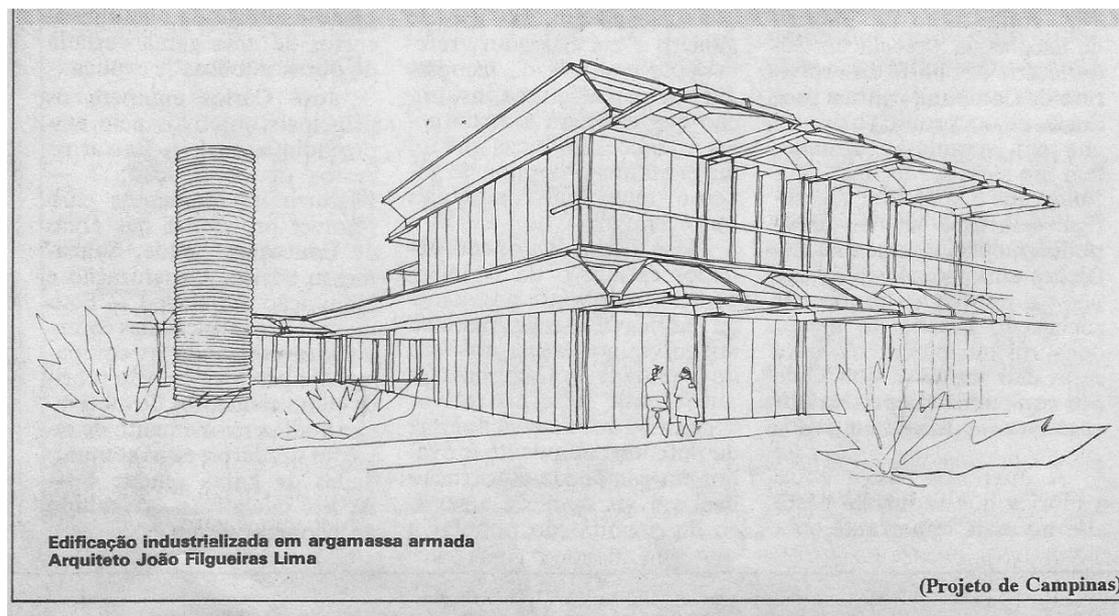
Perspectiva do projeto para FAC Campinas, em argamassa armada com opção para dois pavimentos. Fonte: ACA, 1991, p. 7.
